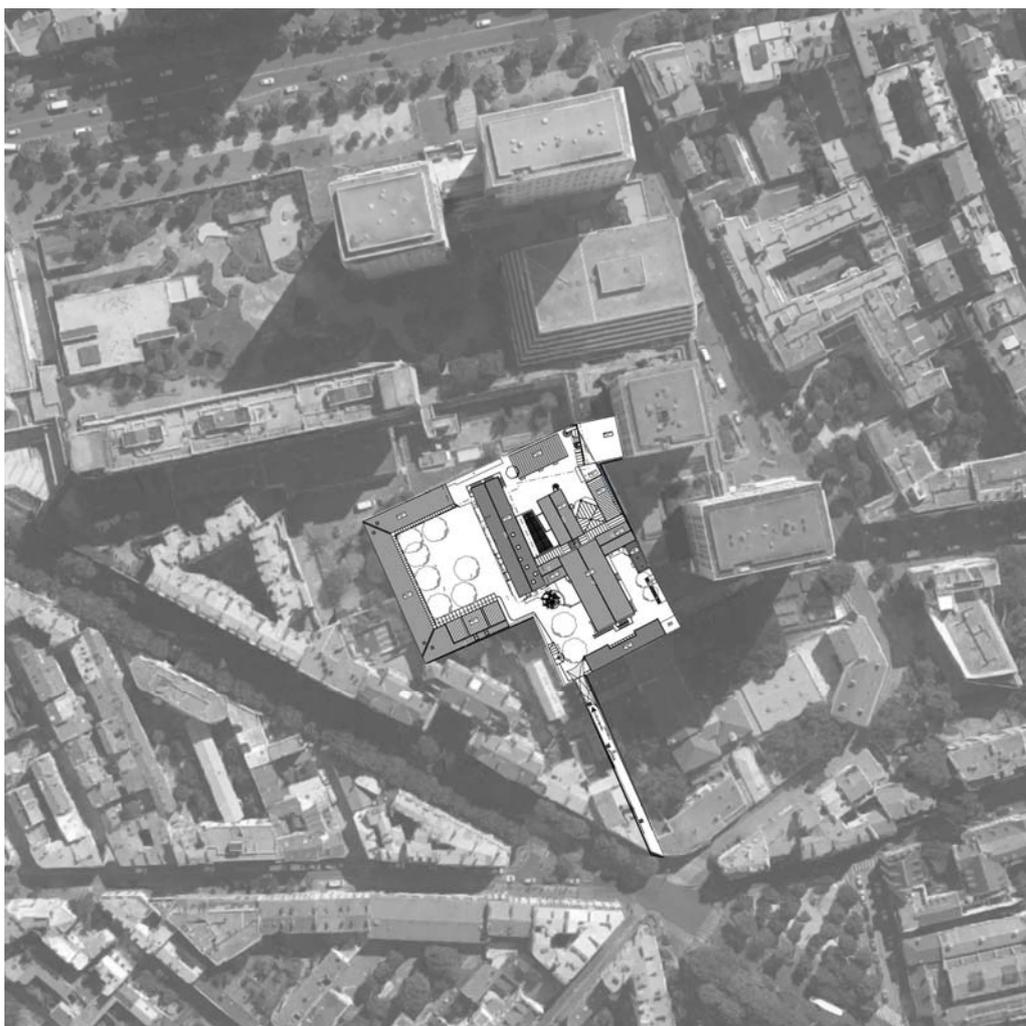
Plan de masse existant avant travaux / © Rouge Basilic
